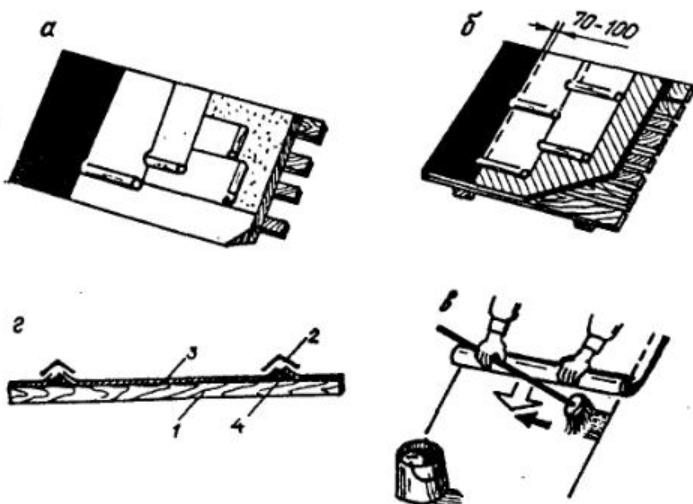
Кровля из рулонных материалов: а — настилка рубероида в два слоя перпендикулярно друг другу; б — настилка рубероида в два слоя параллельно со сдвигом; в — ведение наклейки рубероида; г — укрепление краев рубероида брусками. 1 — настил; 2 — толевый колпак; 3 — рубероид в два слоя; 4 — бруск.
